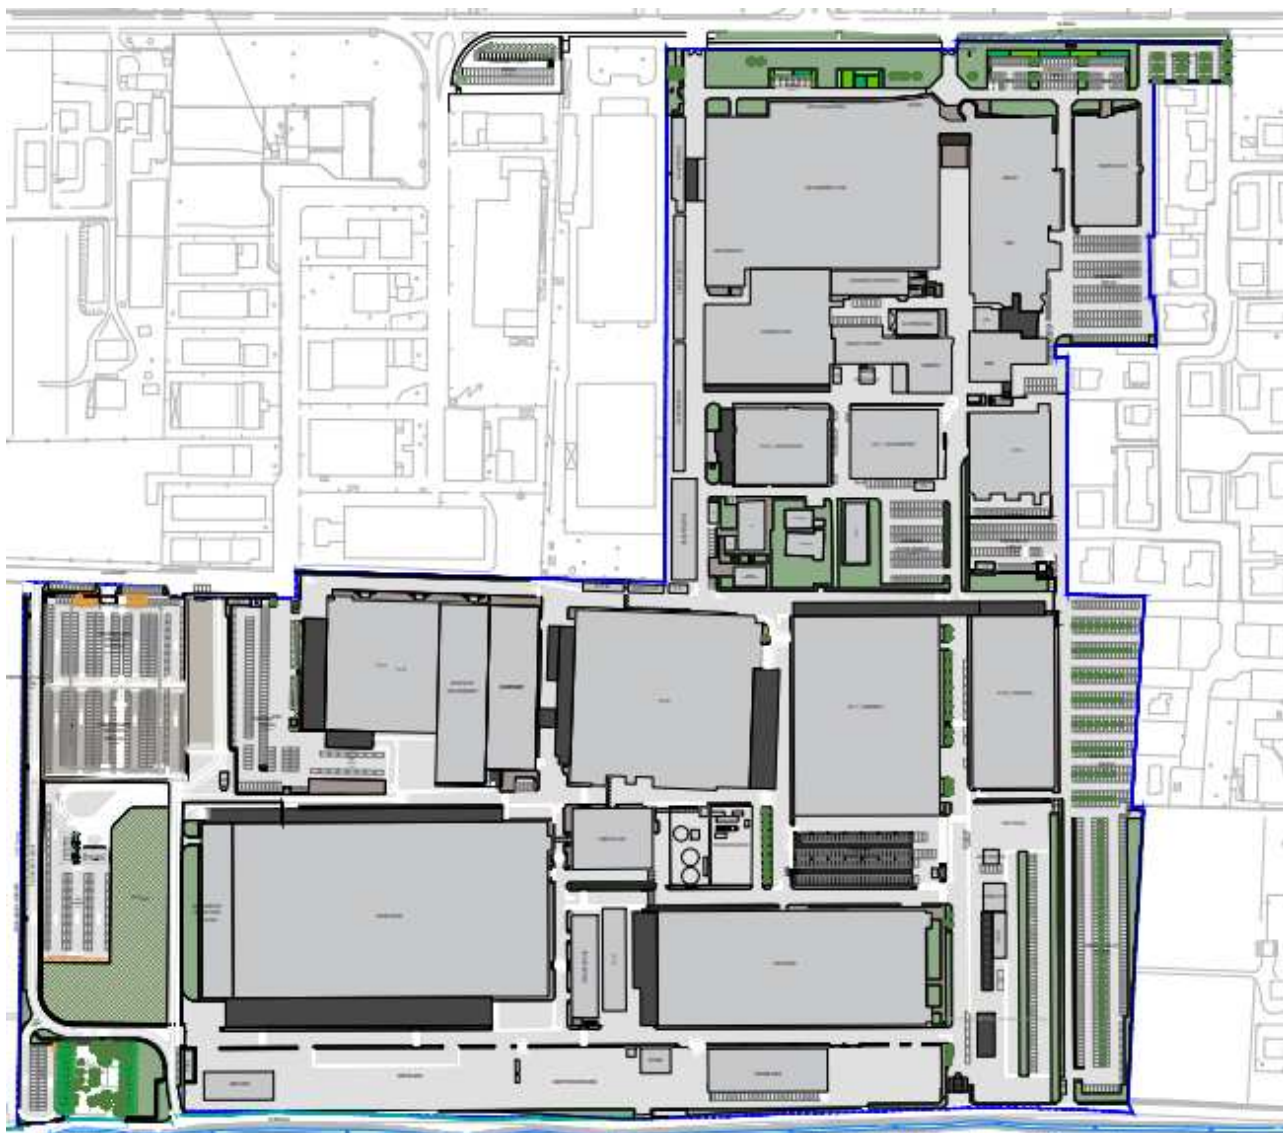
planimetria generale dell'impianto Automobili Lamborghini S.p.A.
